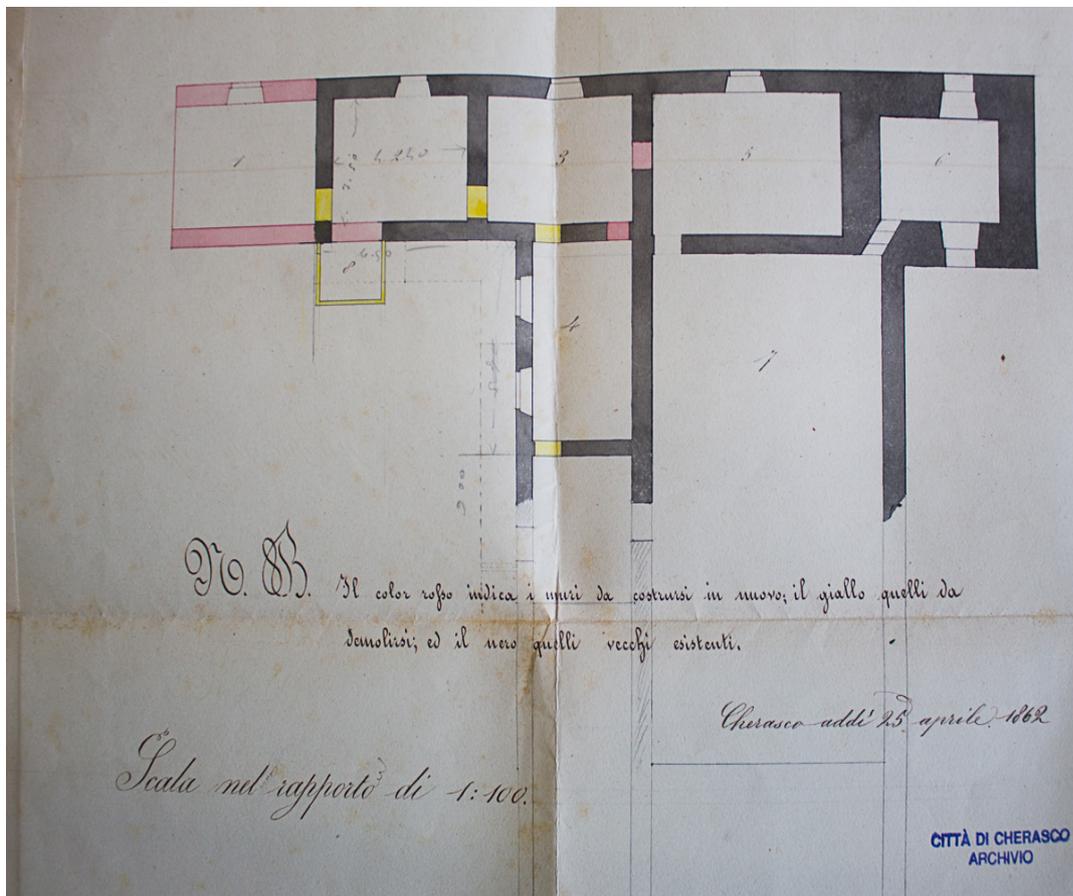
Progetto di aggiunta camera al piano primo, 1862¹⁶
